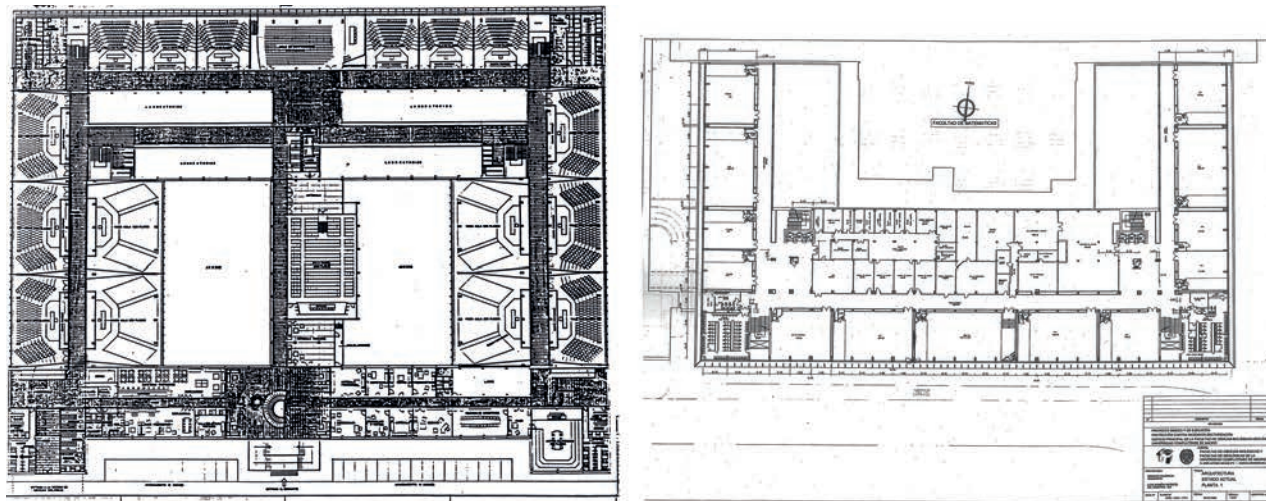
A la izquierda el plano del edificio proyectado originalmente donde aparecen grandes aulas y un pabellón central, en la imagen de la derecha plano de la planta primera del edificio actual (Fuente: UCM).
